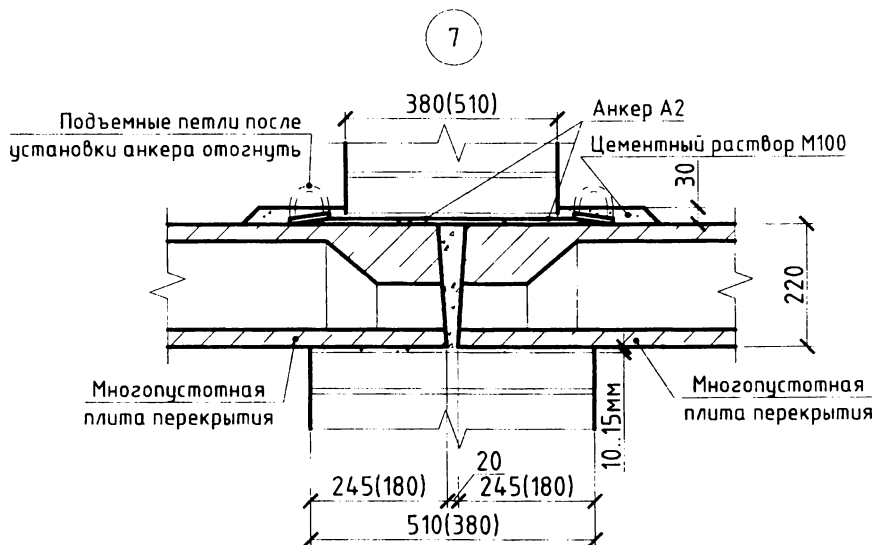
Узел опирания усиленных торцов круглопустотных плит перекрытия на внутреннюю несущую стену из кирпичной кладки (смотреть совместно с рисунком 12)
